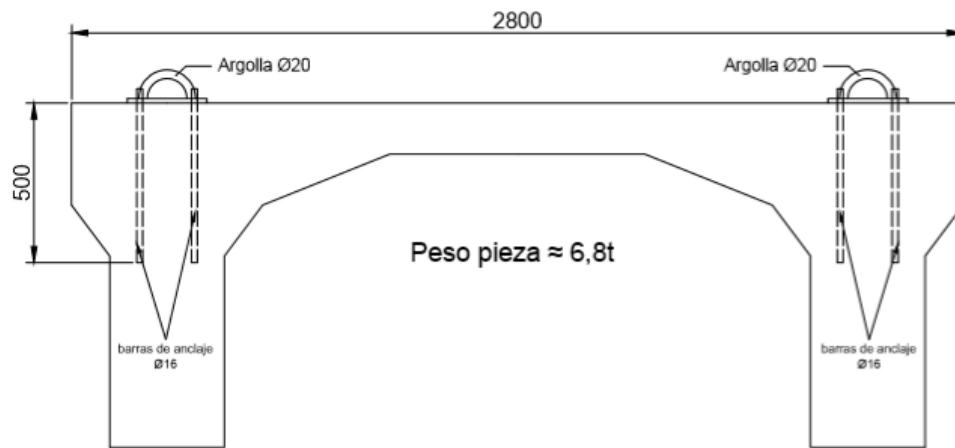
Detalle trasversal de barras de anclaje, chapa y argolla.
